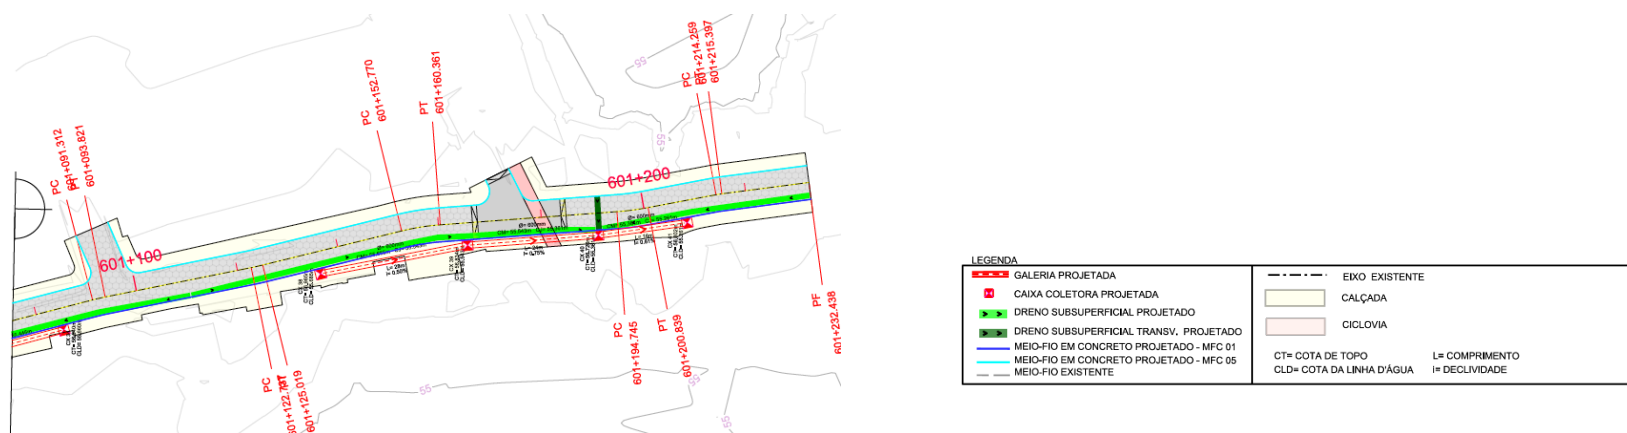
Imagens das Plantas de Drenagem do Projeto – Segmento Estaca 601+077 à Estaca 601+232.
